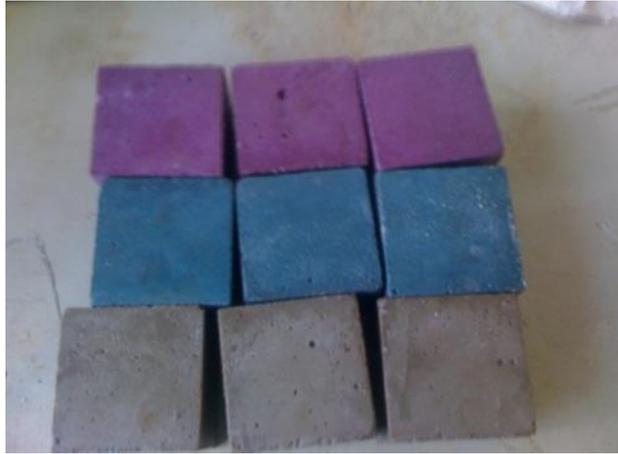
Preparación de mortero con pigmento fluorescente
